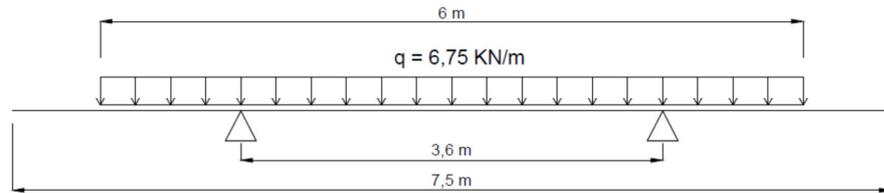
Viga teórica para el cálculo de las vigas transversales apoyadas sobre las vigas Tensairity®. Cortante máximo
